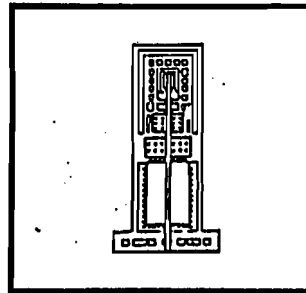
Simetri;Redentore Church;A.Palladio;thn1576-1591
